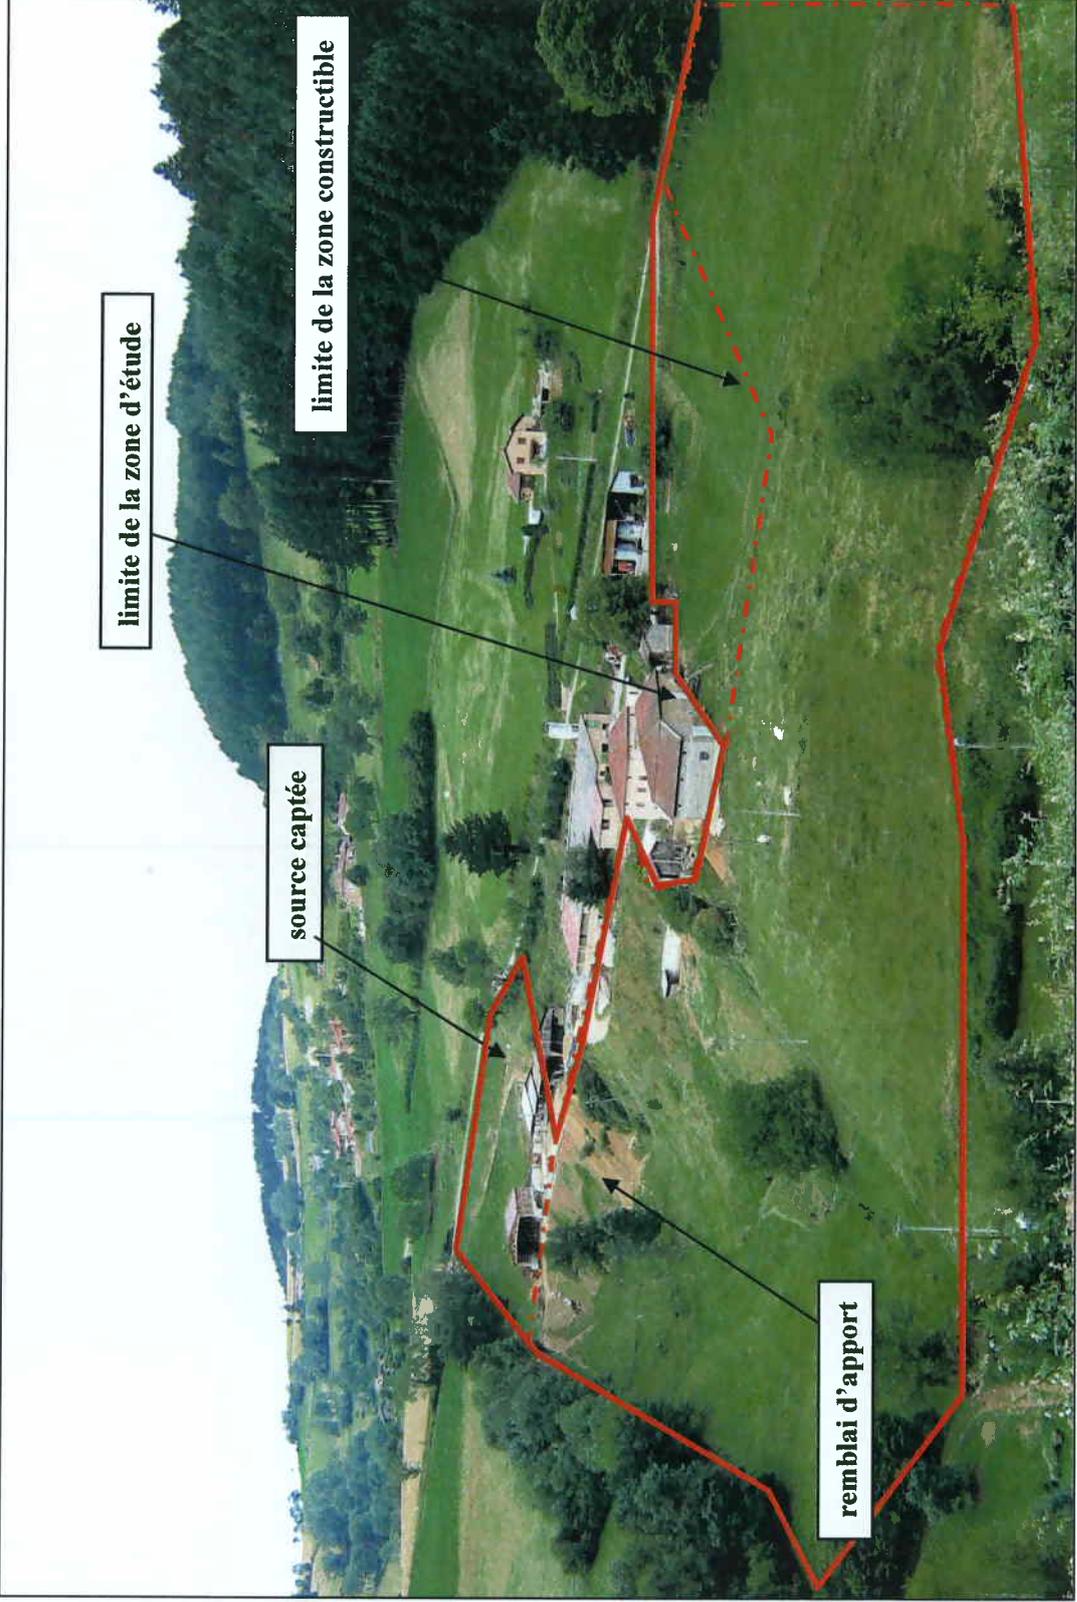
vue d'ensemble de Frigalet (secteur 3) -- parcelle 168
